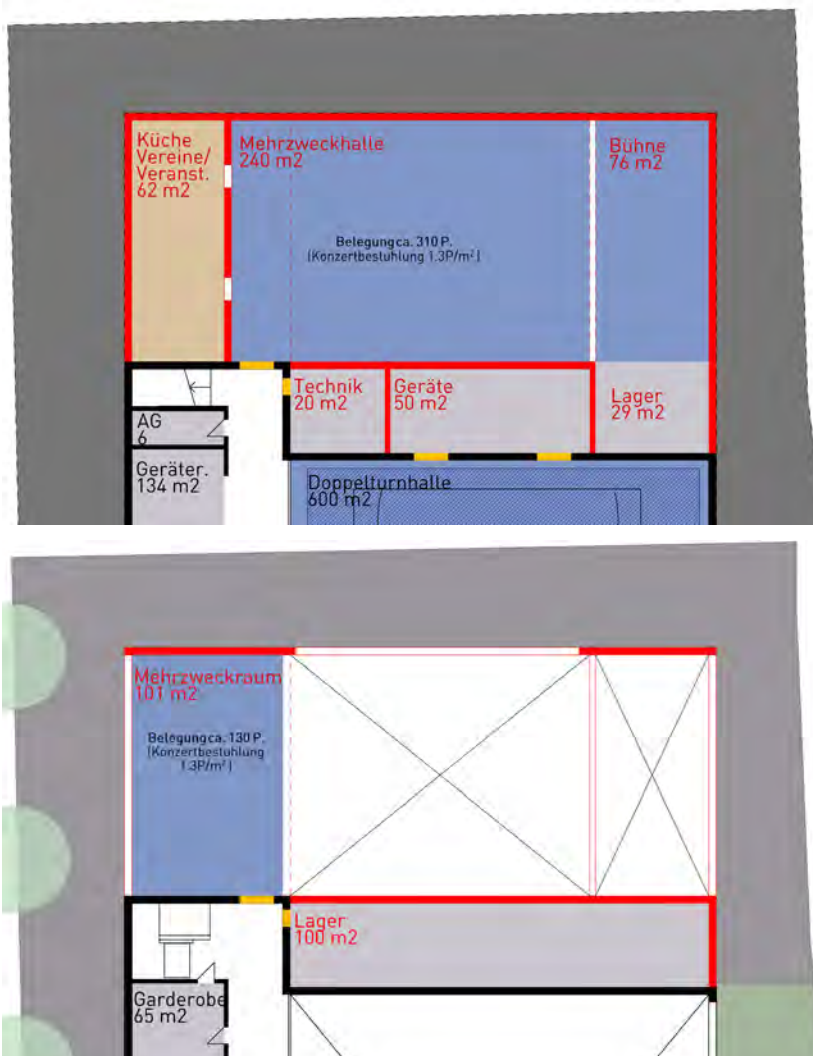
Grundriss, Mehrzweckhalle im Unter- und Erdgeschoss
